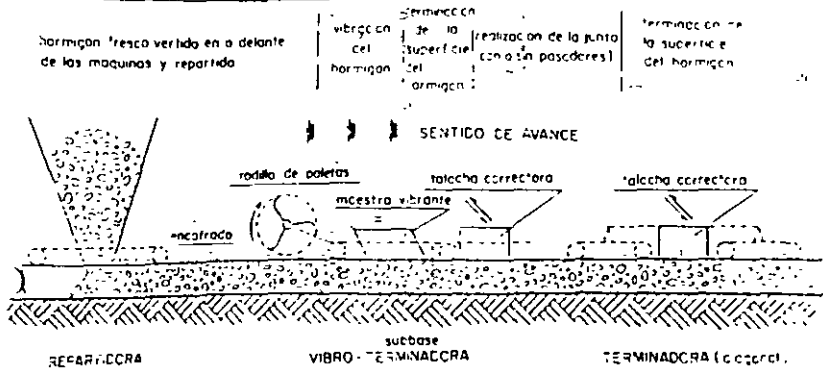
Pavimentadora de hormigón de guiado automático.
